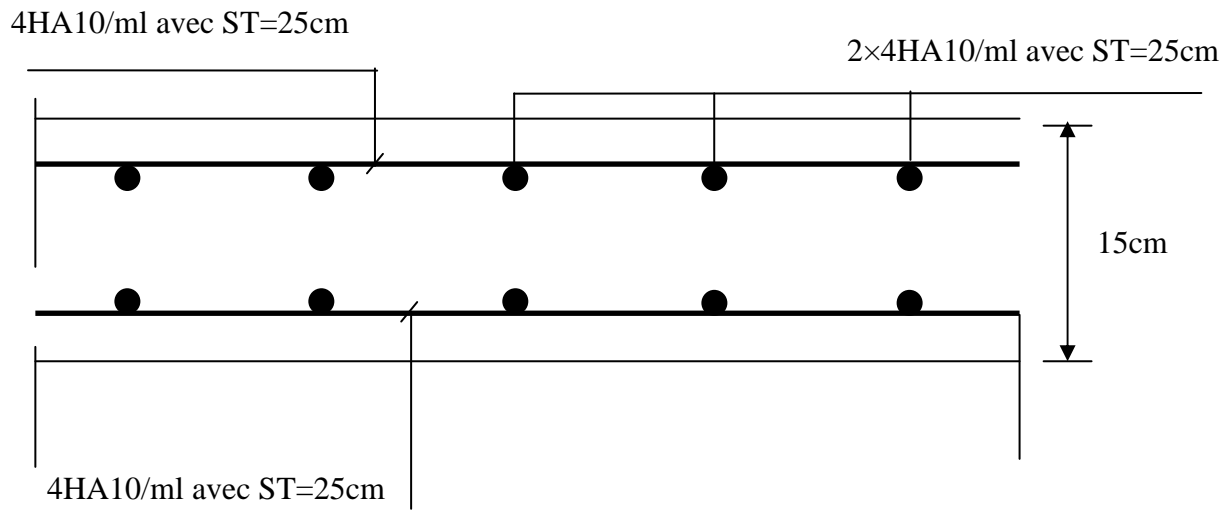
Ferrailage de la dalle dans le sens y-y.
